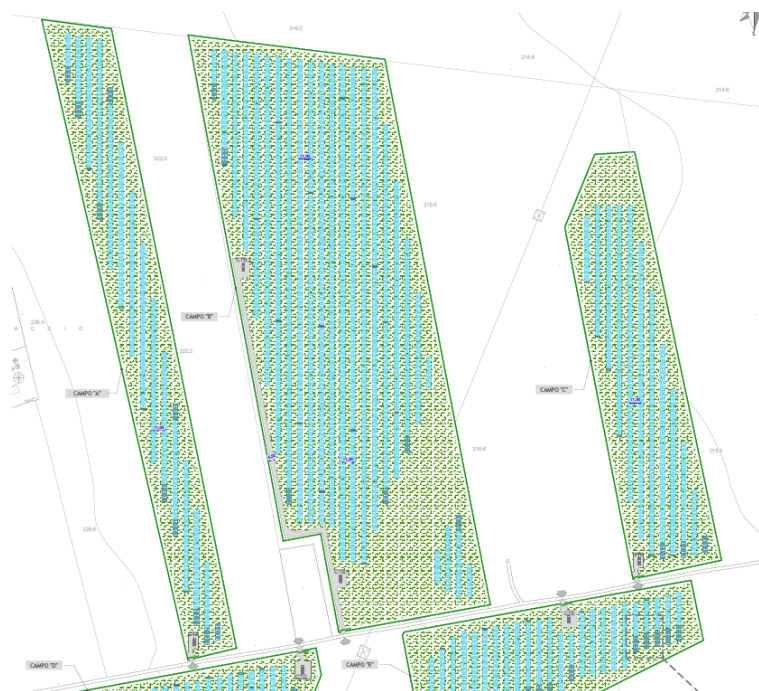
Planimetria dell'Impianto Fotovoltaico - Campi A, B, C
